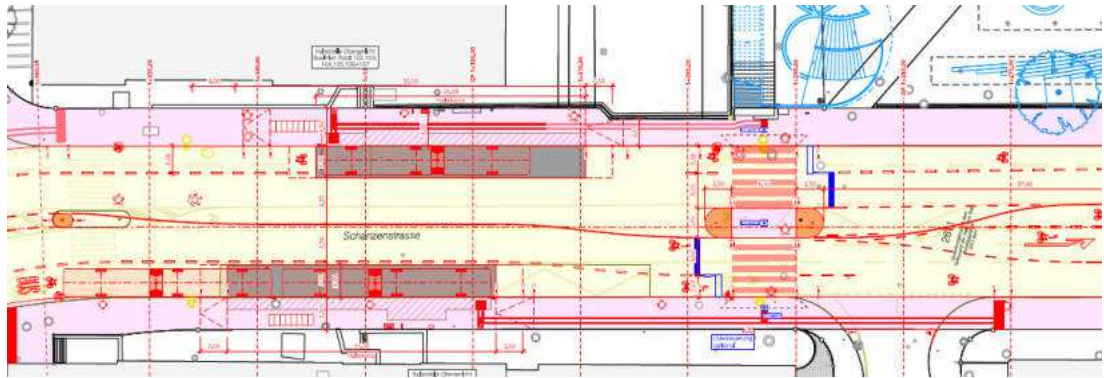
Ansicht des Elements (Quelle: Plan 4-1 Situation mit Flächen Schanzenstrasse Nord )
